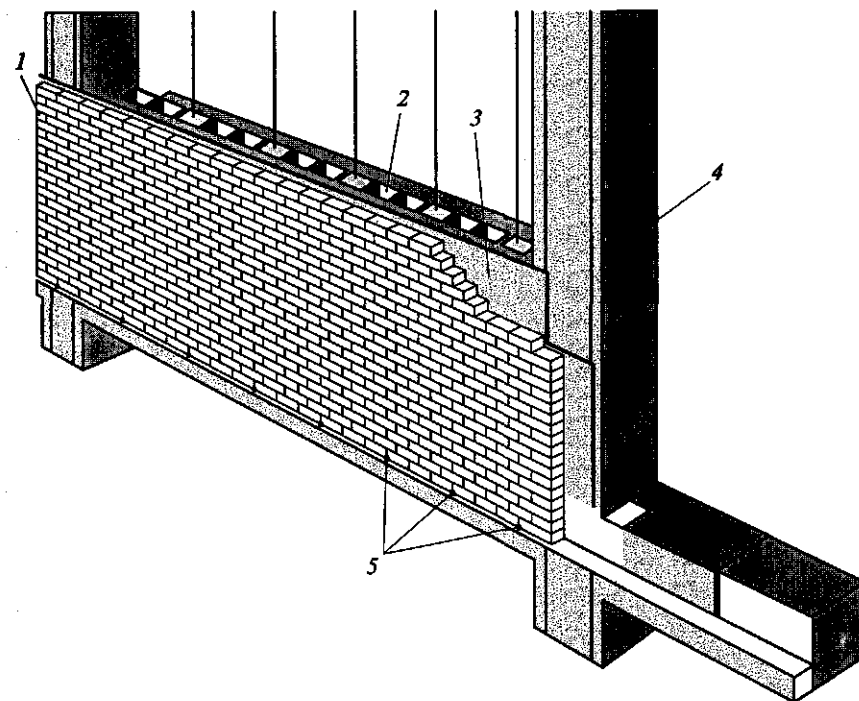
Мелкоблочная вентилируемая кладка со связями:
